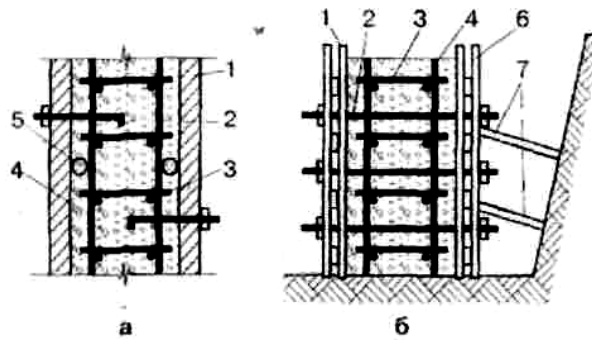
Схема бетонування конструкцій з використанням незнімної опалубки:
